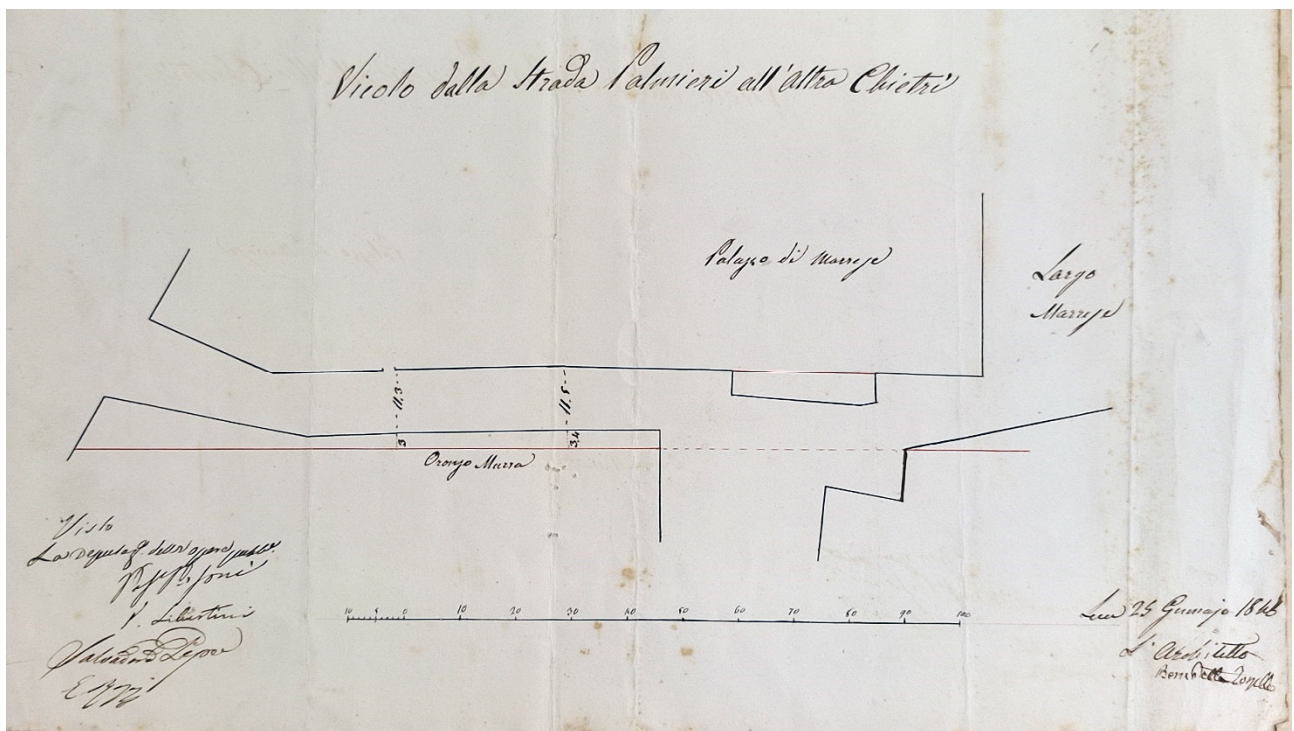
Pianta del vicolo tra la strada Palmieri e Chietri, Lecce, 1846 (ASL, Int. Aff. Part.ri).
